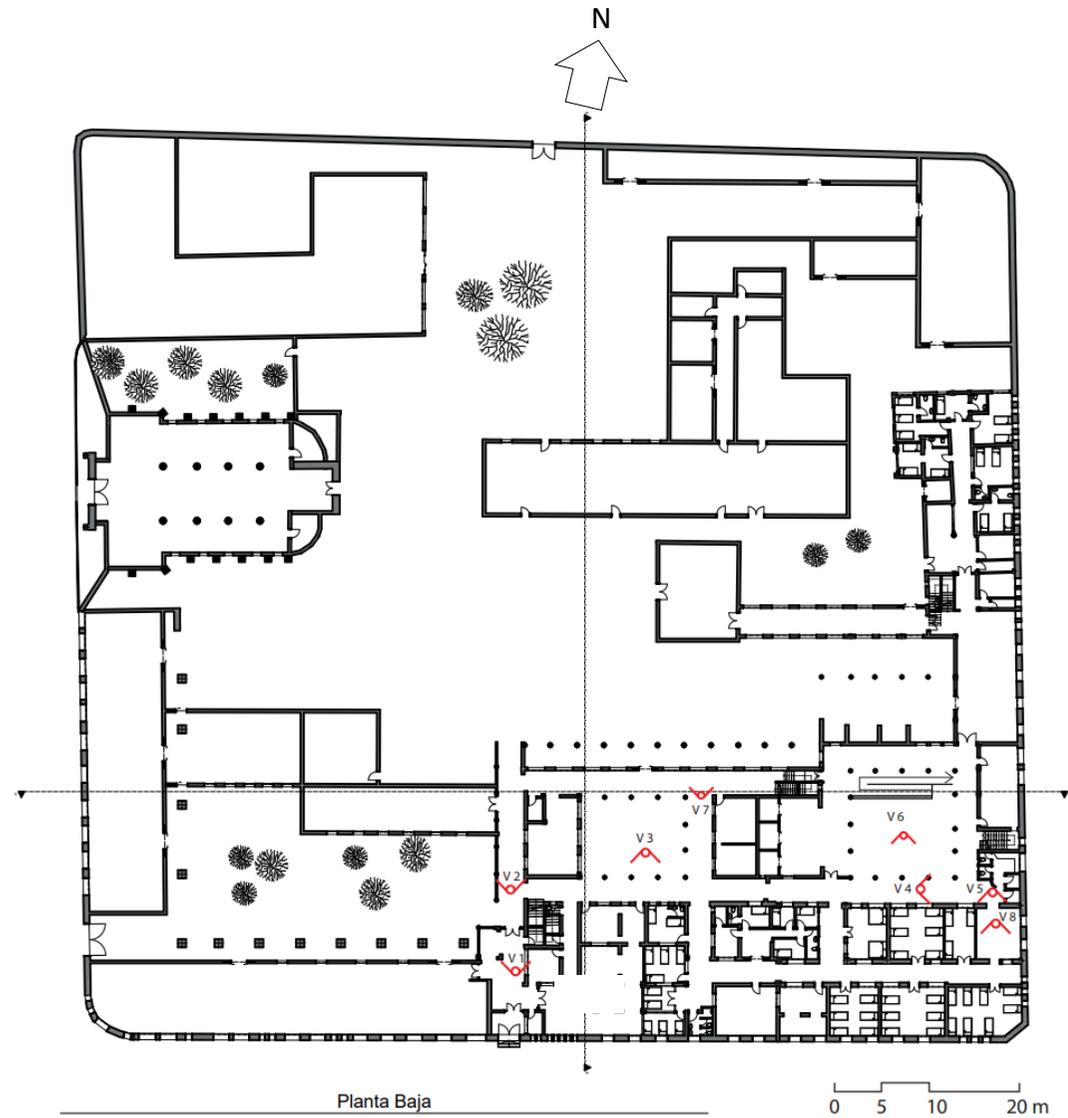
Planta baja “vistas” Hogar Cristo Rey.
